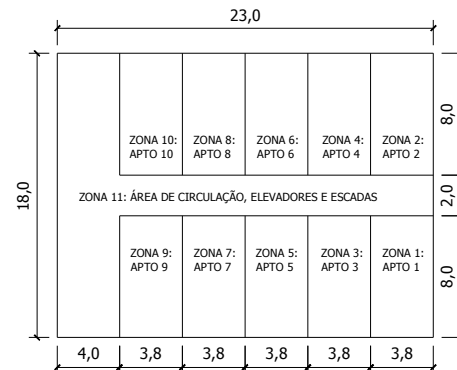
Divisão do pavimento tipo em 11 zonas térmicas.
